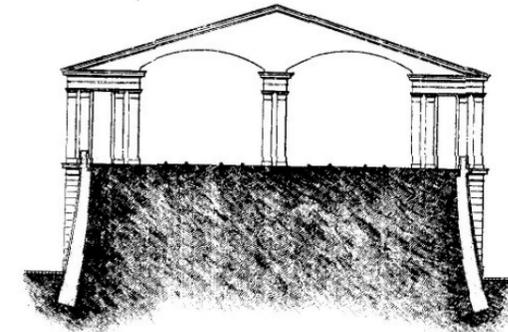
Ansicht Westfassade, Zeichnung, 1842
